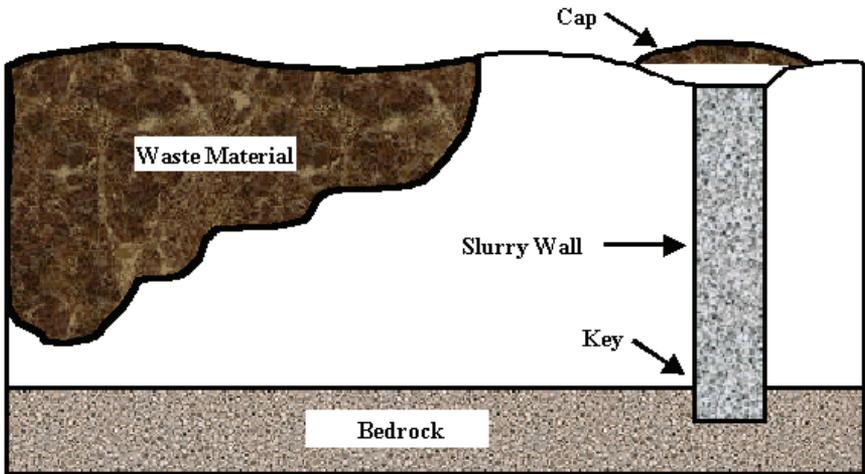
Corte que muestra el aislamiento del muro pantalla sellado.
